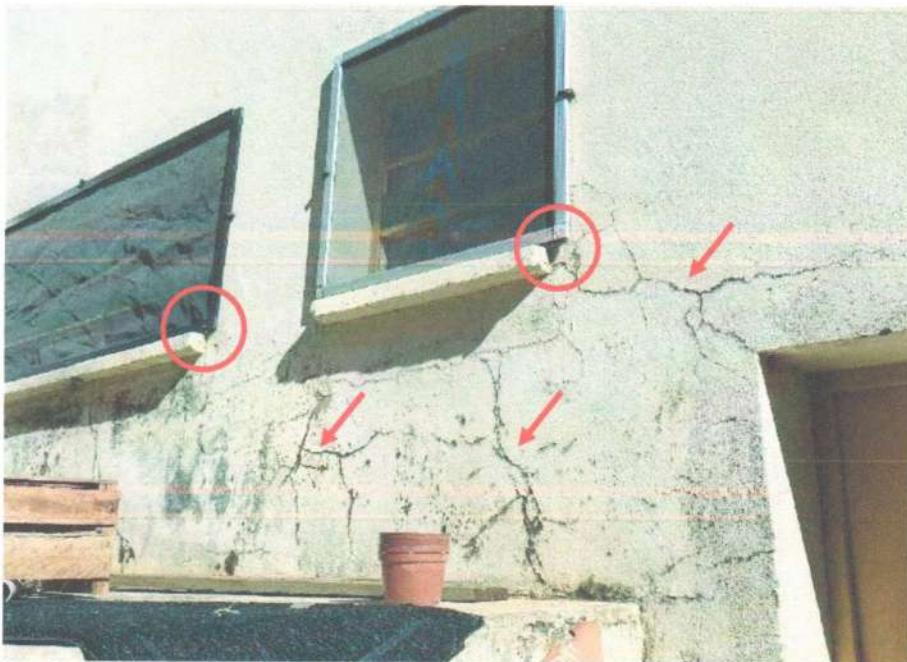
Trincas e/ou fissuras e deficiência nas pingadeiras (Prioridade II, Classificação 3)
